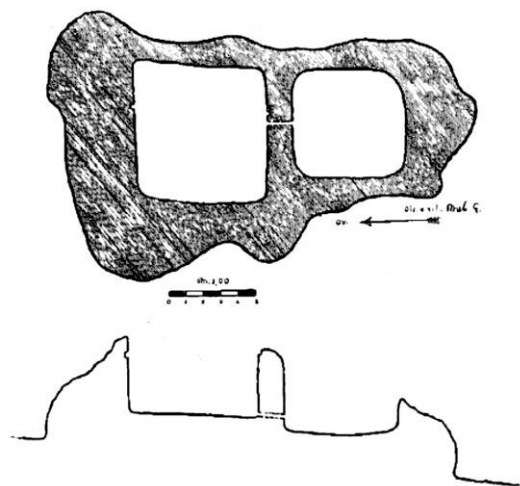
Palmento di contrada Muratore; planimetria e sezione effettuata dal Mingazzini
